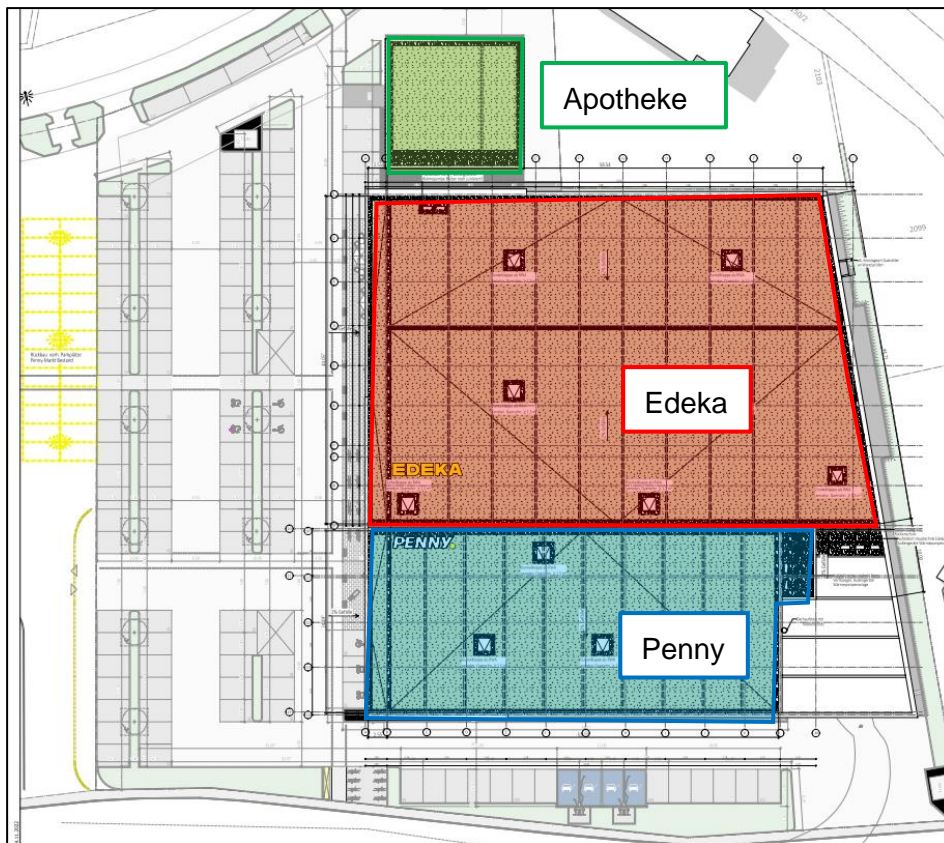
Grundriss Vorhaben mit Außenanlagen
